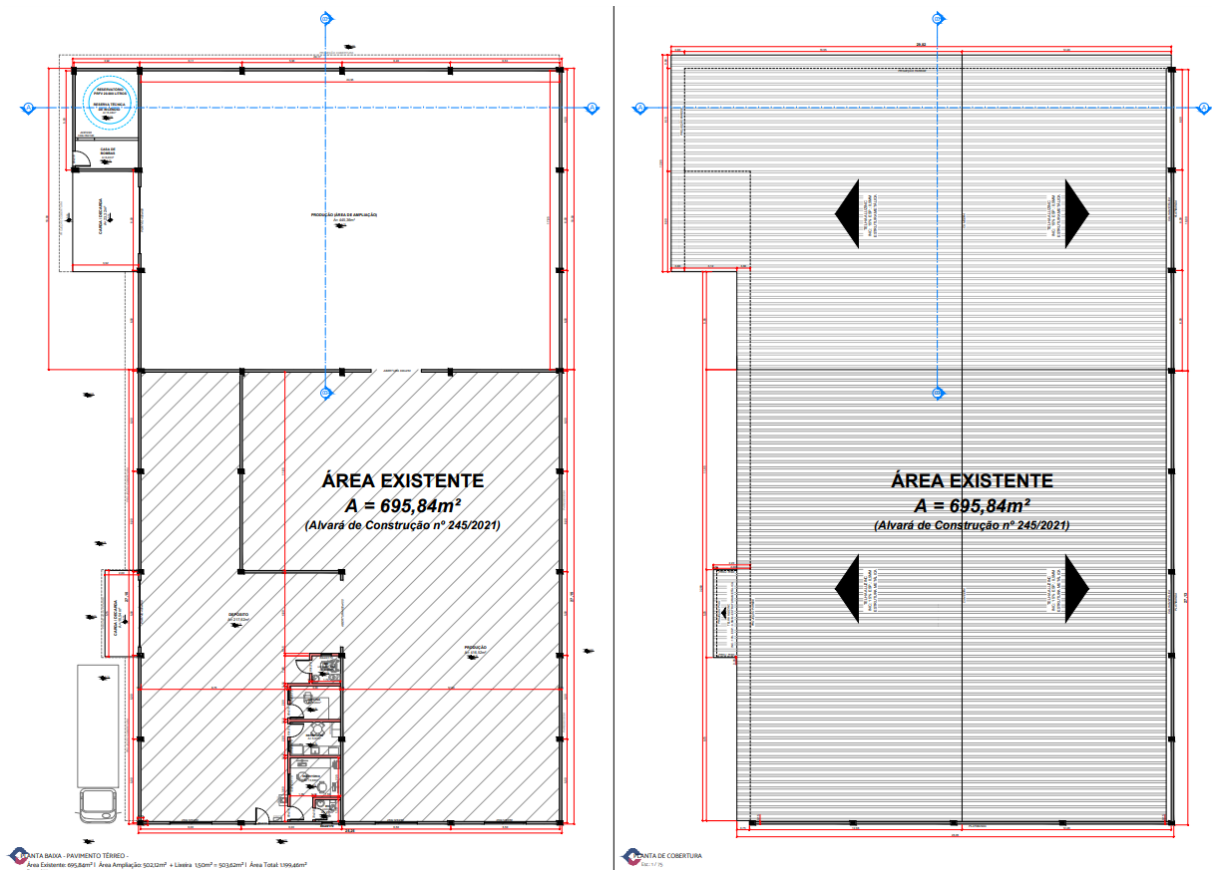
Planta baixa e planta de cobertura da edificação a ampliar.
